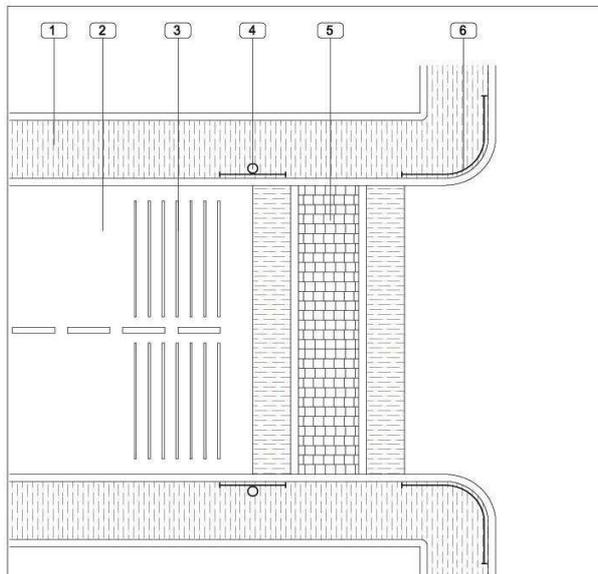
pianta incrocio stradale con attraversamento rialzato alla quota del marciapiede
